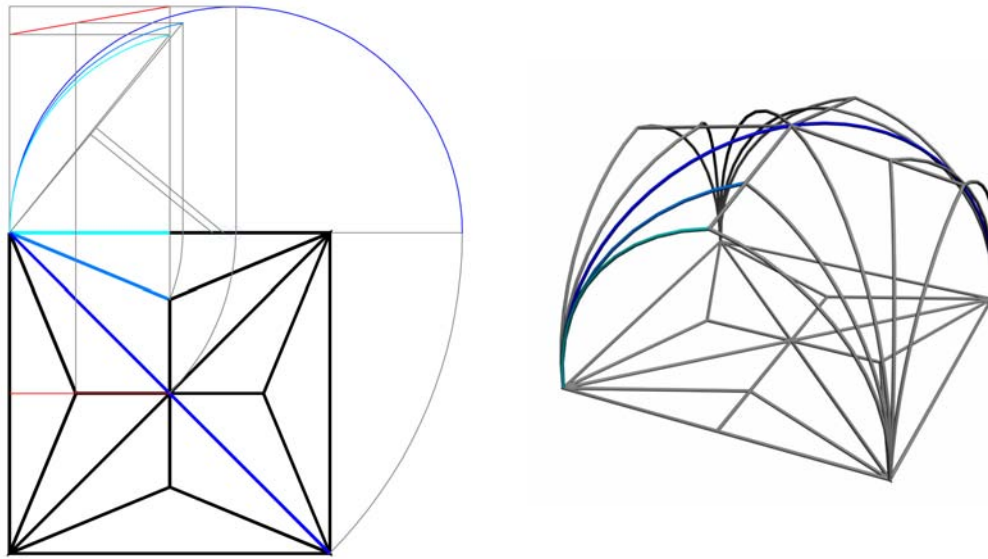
Schematizzazione in pianta e alzato delle tracce delle nervature della volta a crociera sarda.
